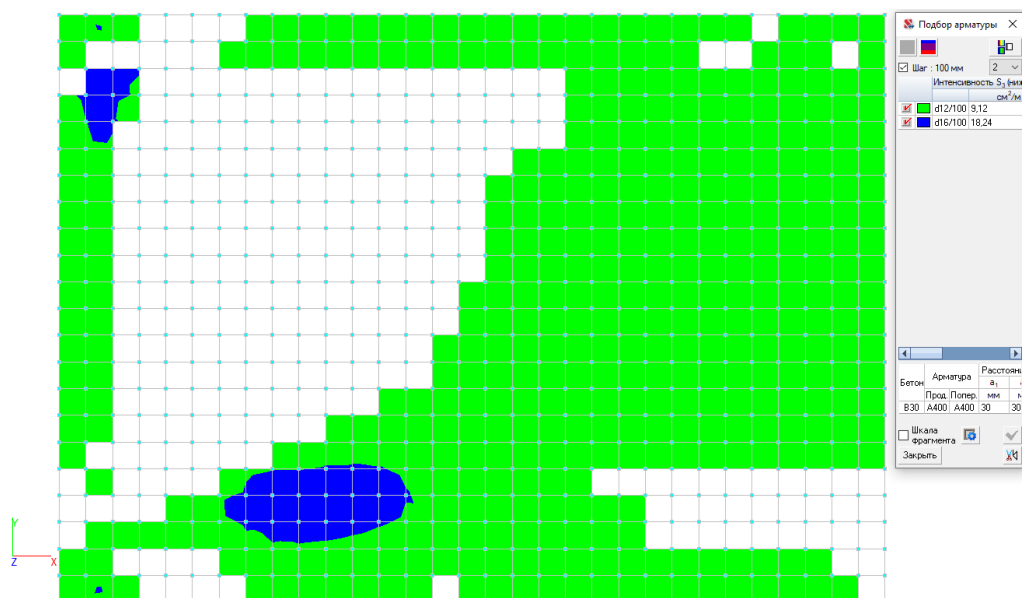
Интенсивность армирования нижнего пояса плиты перекрытия по ОУ
